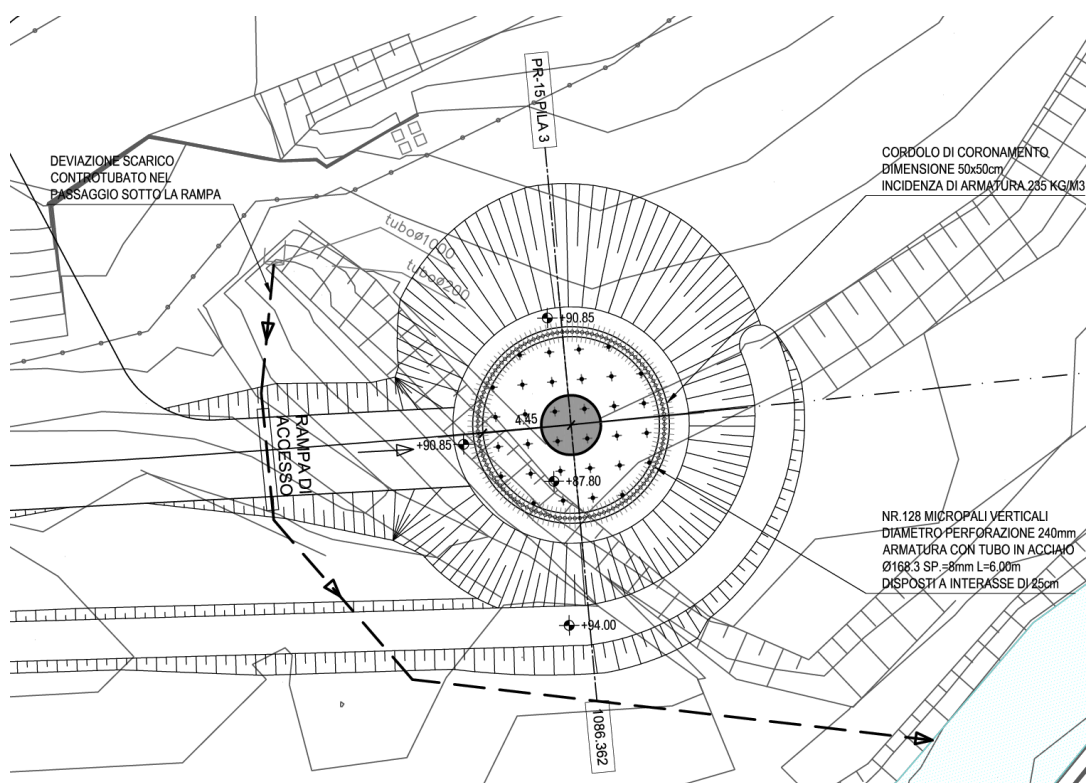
Stralcio planimetrico opera provvisoria pila 3.
